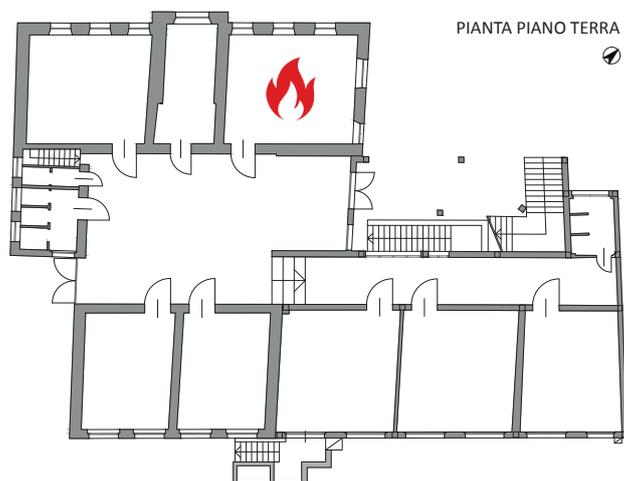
Figura III - Planimetria del piano terra con indicazione di dove sorge l'incendio considerato
